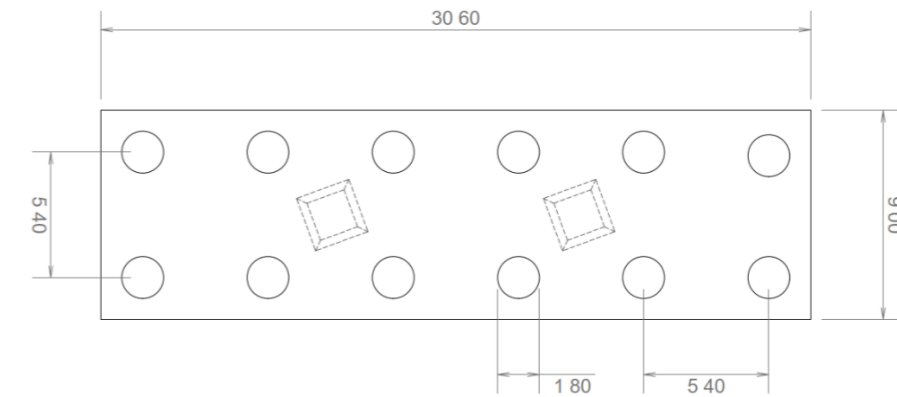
Vista en planta de los encepados y pilas (fuente: elaboración propia)
